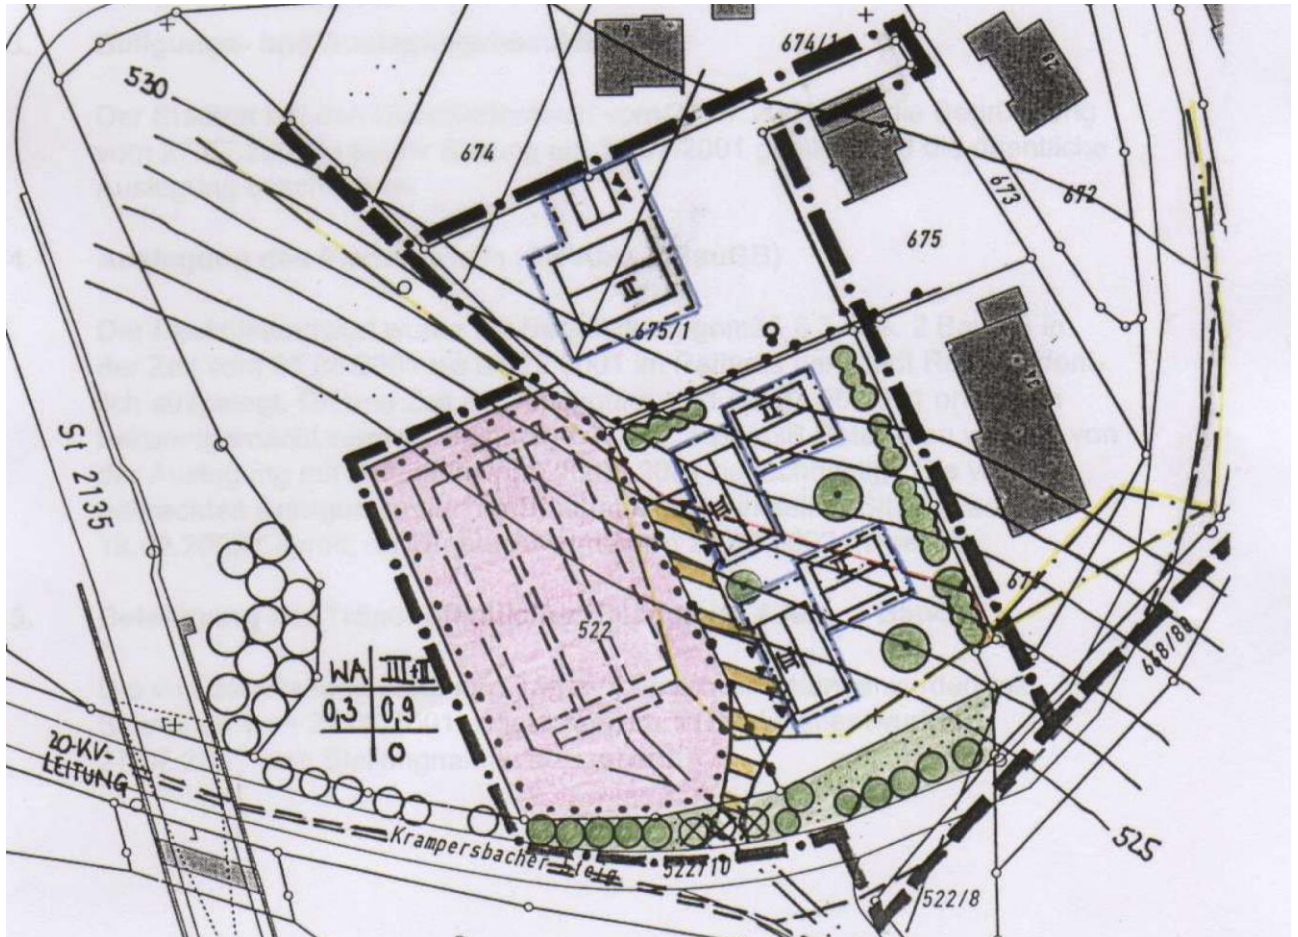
Auszug aus dem Deckblatt Nr. 14 des Bebauungsplans „Bürgerholz – Süd“ – Maßstab 1:1.000
